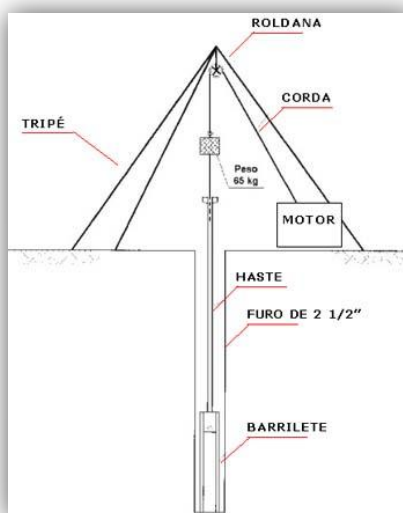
Montagem de equipamentos para ensaio SPT (Fonte: Fórum da Construção¹)
